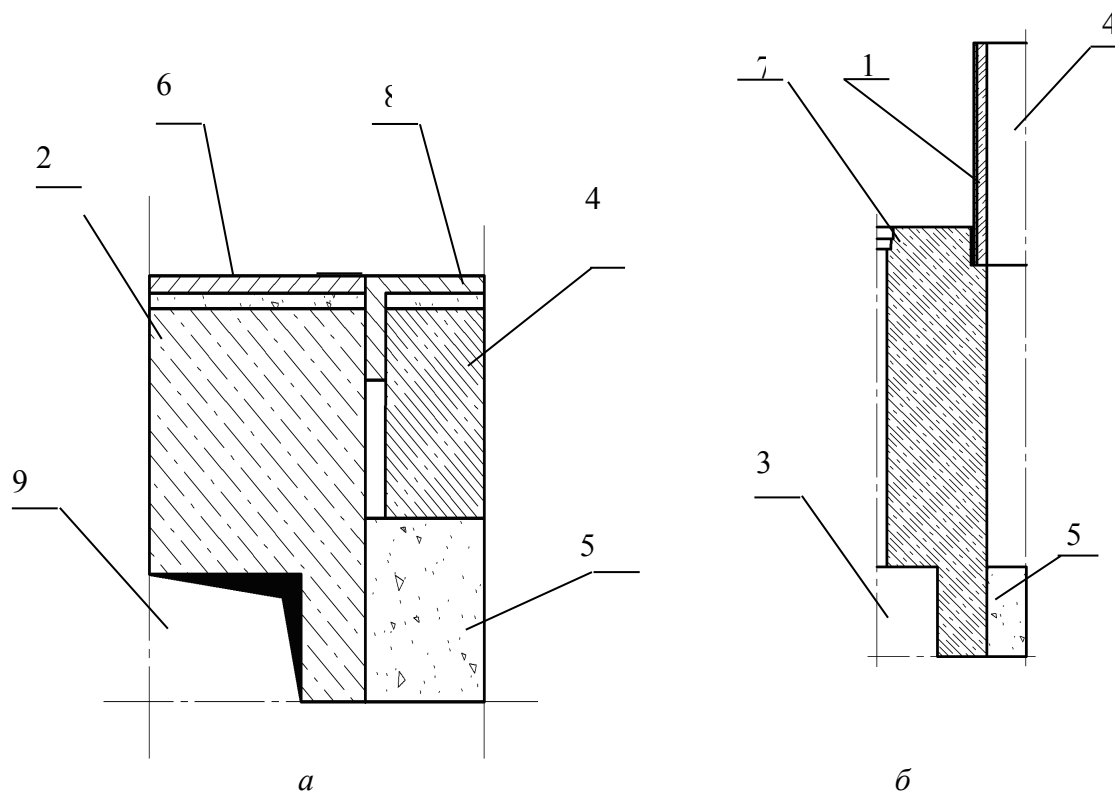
Расчетные схемы выбросоопасных узлов: а) узел типа «крышка», б) узел типа «труба в кладке»: 1 - труба, 2 - кладка печи, 3 - окно рециркуляции, 4 - футеровка, 5 - перерабатываемый материал, 6 - армированные кладки, 7 - кладка перекрытия, 8 - крышка, 9 - отопительный канал
